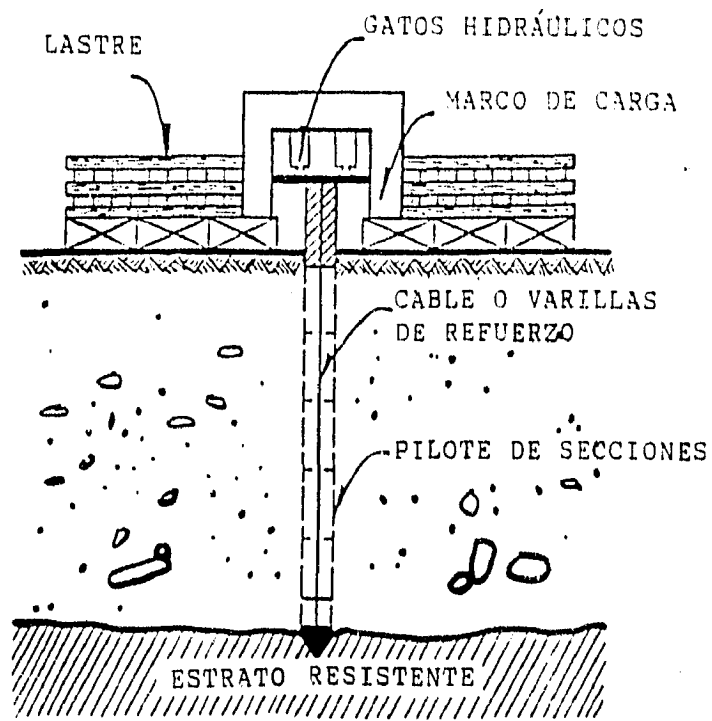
PILOTE HINCADO A PRESIÓN.
